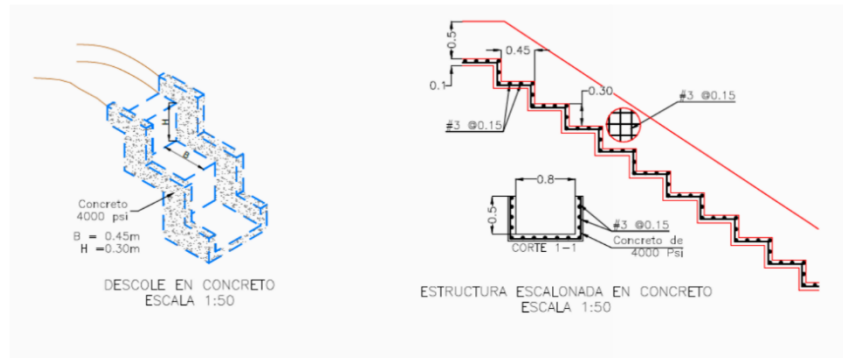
Detalles constructivos de la cuneta que finaliza en un descole a la quebrada El Chuscal.
